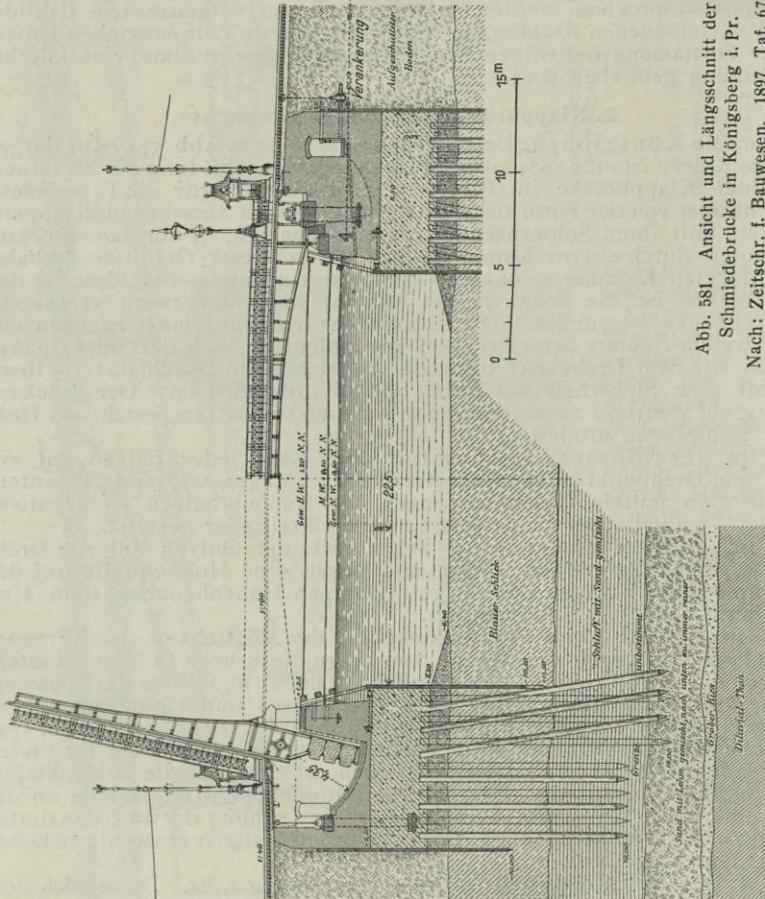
Ansicht und Längsschnitt der Schildebrücke in Königsberg i. Pr.
